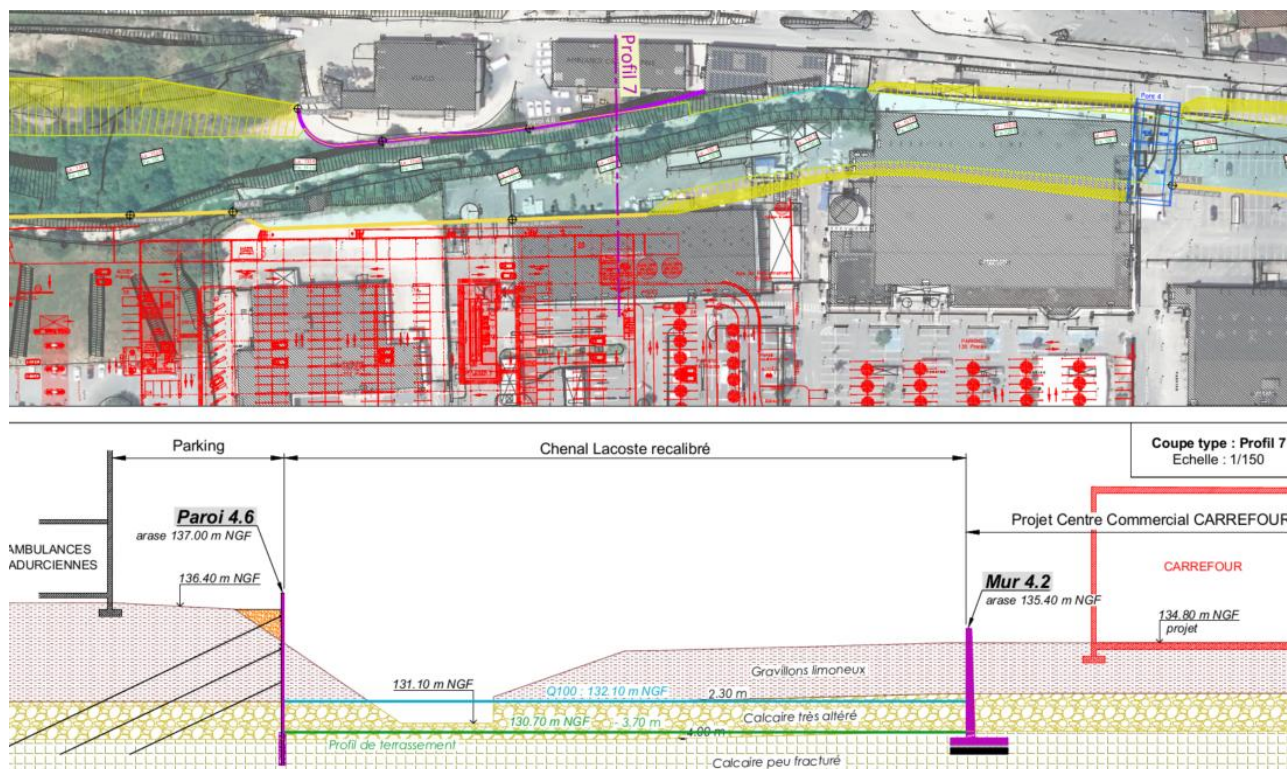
Coupe type de terrassement – Secteur VULCO et CARREFOUR
